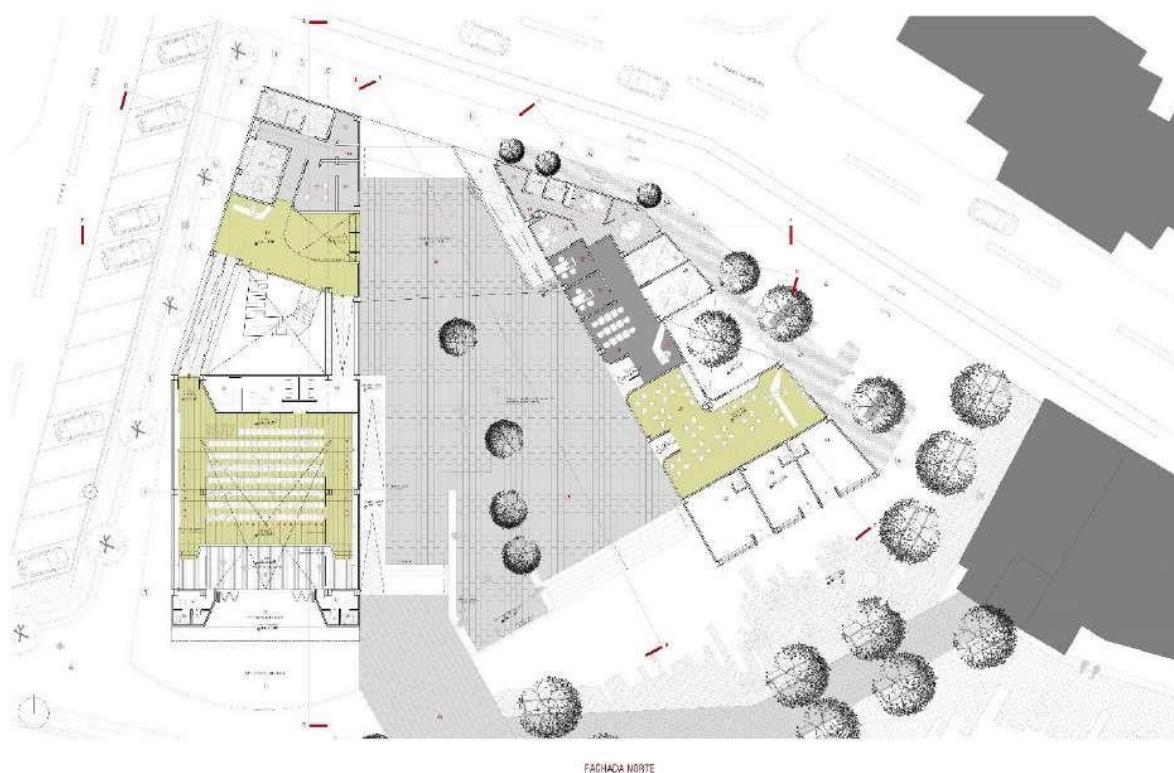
Planta de segundo piso (Fuente: Elaboración propia)
